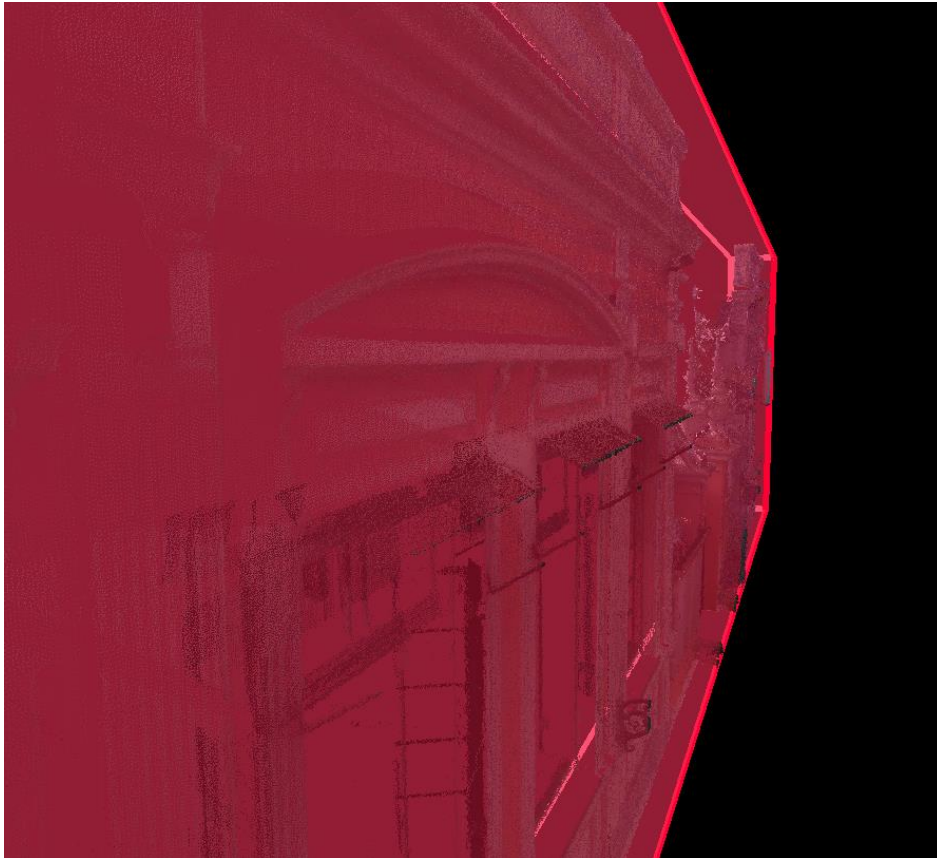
Recorte da nuvem de pontos para a área de interesse das fachadas
